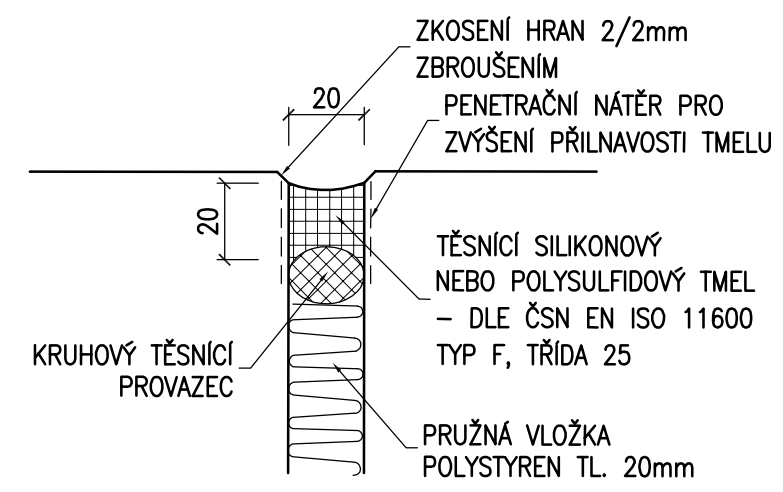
DETAIL SMRŠTOVACÍ SPÁRY 1:5
